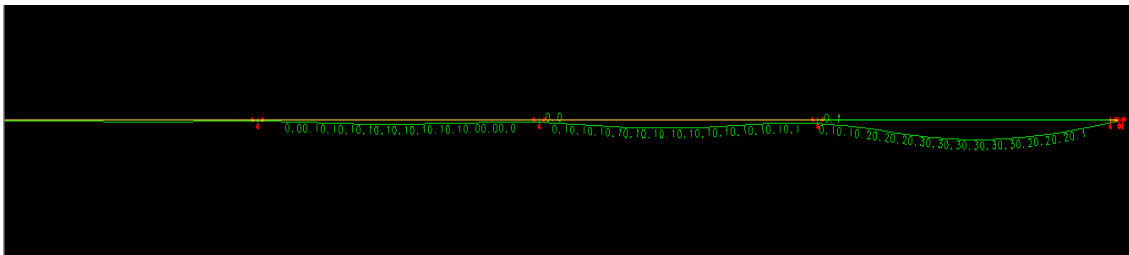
Deslocamentos verticais da viga V2 do 1º pavimento, concreto armado (CAD/TQS).
